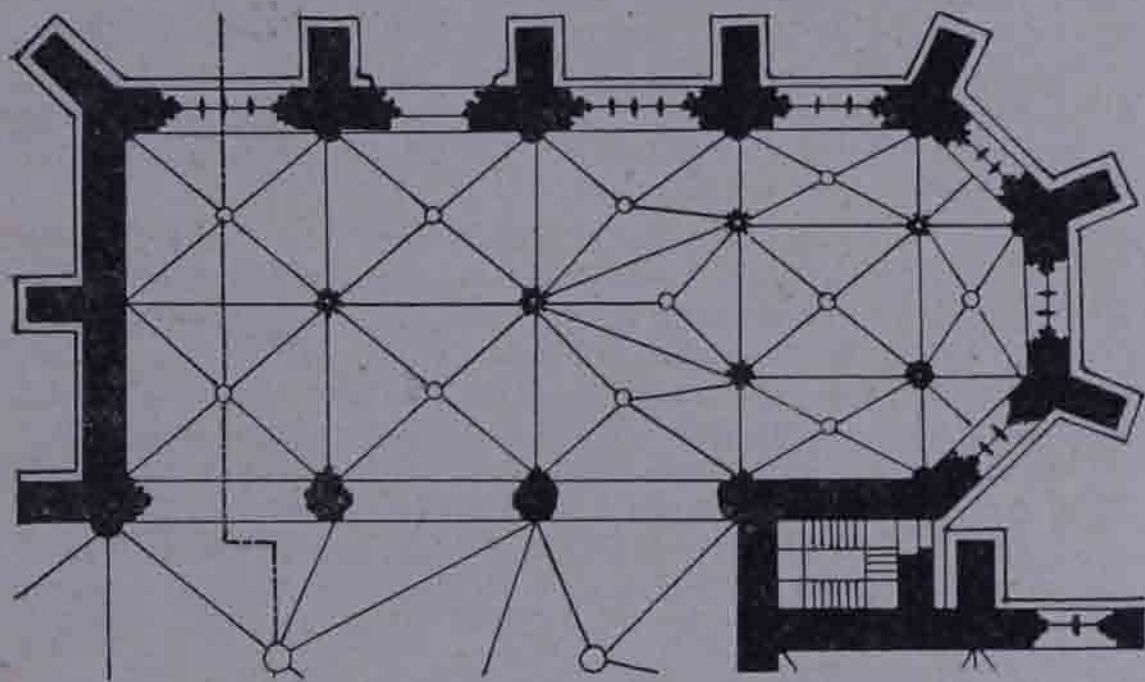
Enns, Wallseerkapelle; Grundriß.
